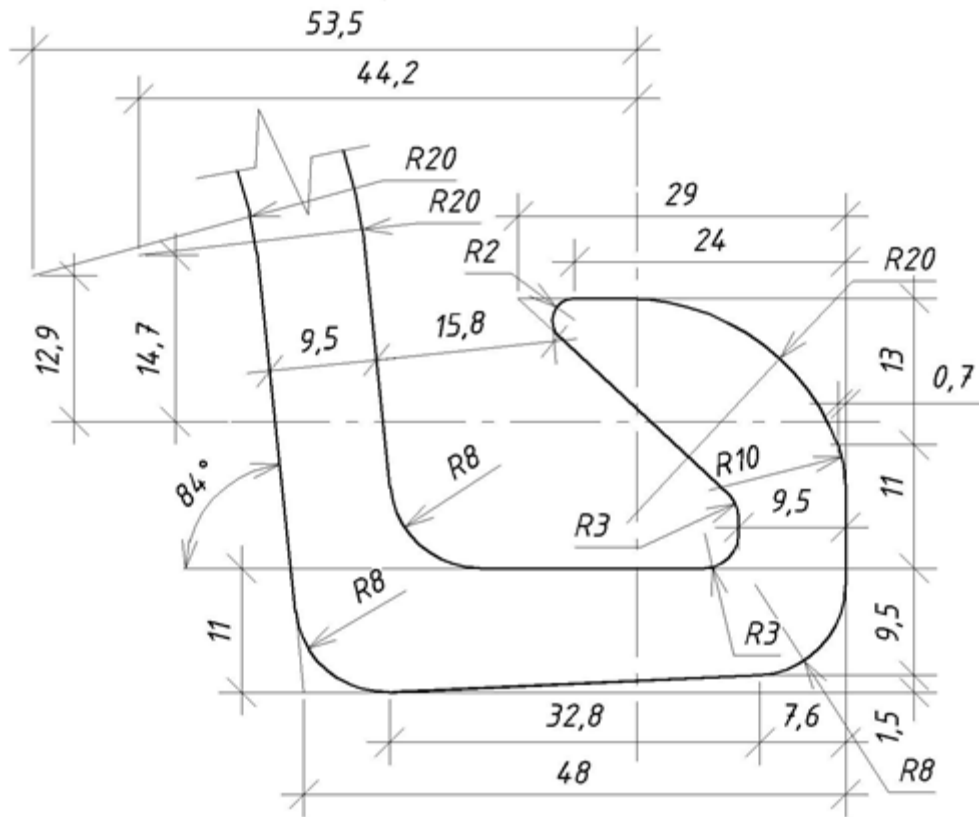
Конструкция шпунта Л6-29НТ
